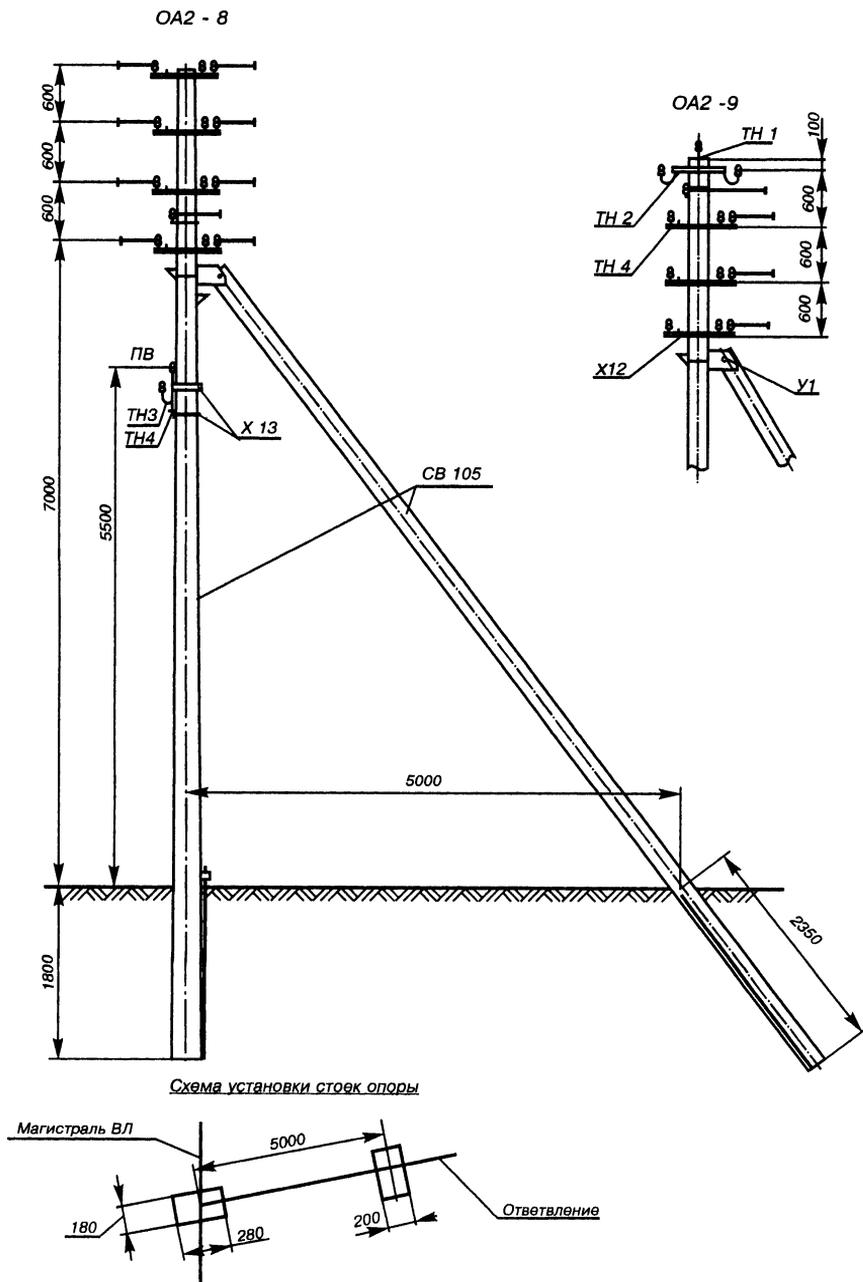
Линейная арматура для ответвительных анкерных опор
